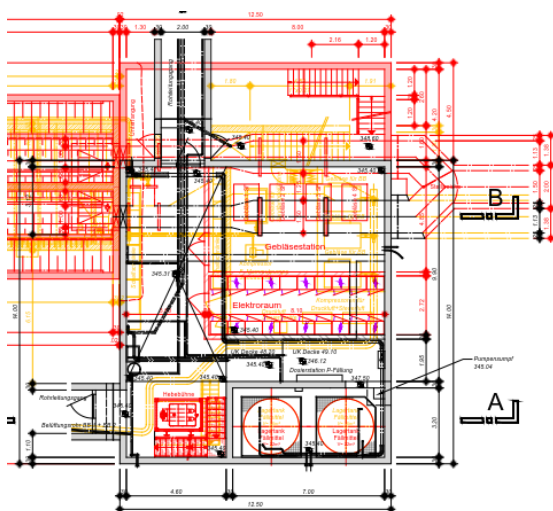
Rechengebäude – Grundriss UG
